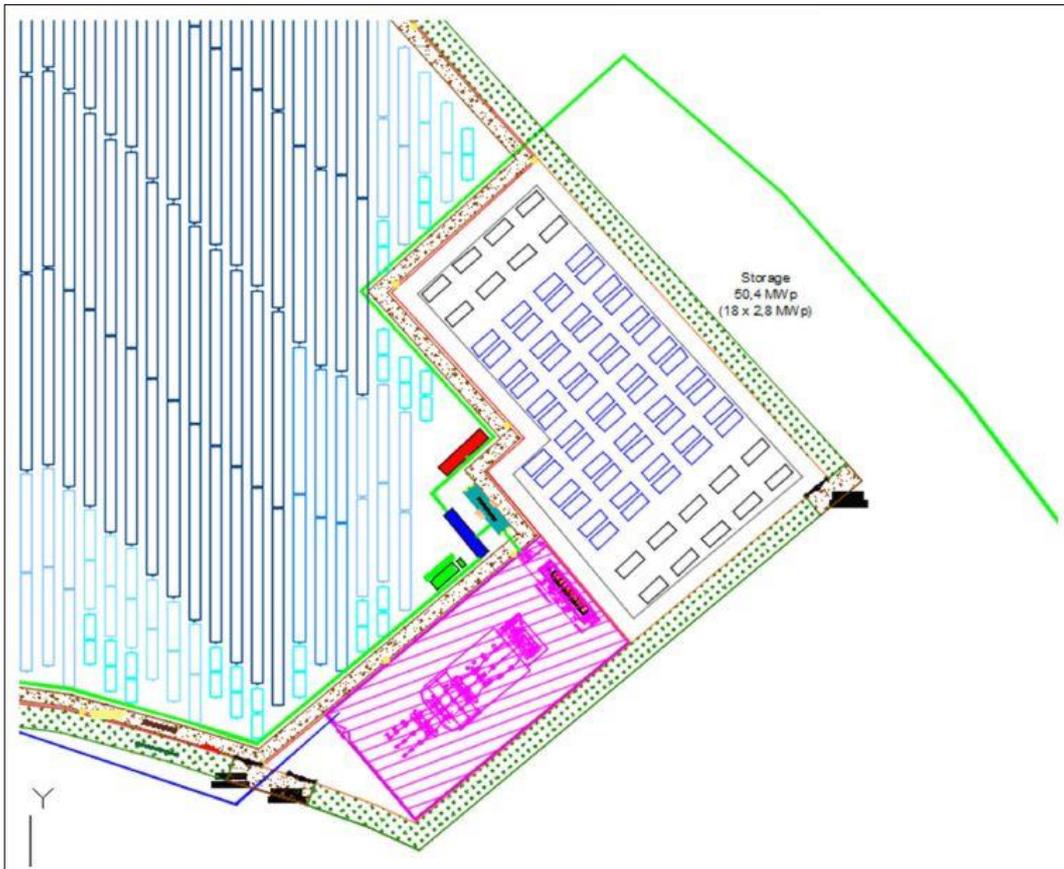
Planimetria specifica di ubicazione dell'impianto BESS;
